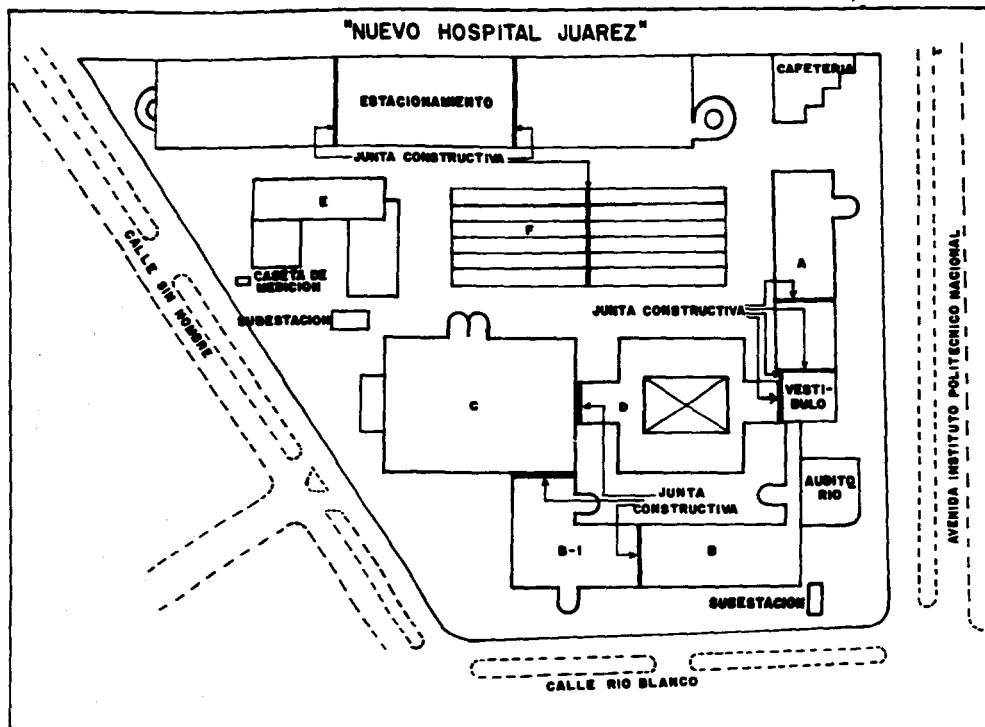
UBICACION DE JUNTAS CONSTRUCTIVAS
